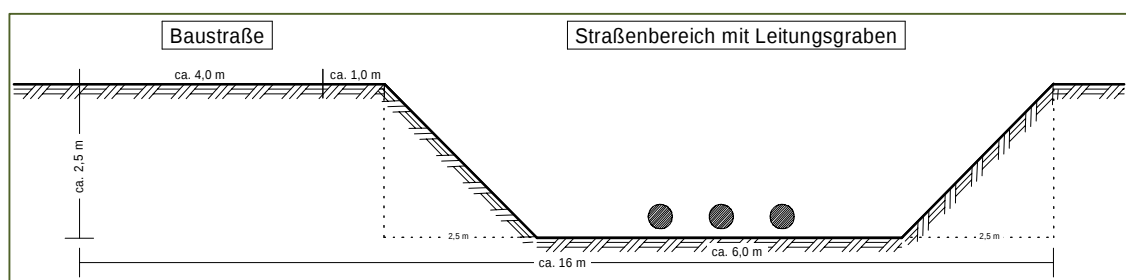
Eingriffsbereich – Straßen- und Leitungsbau
